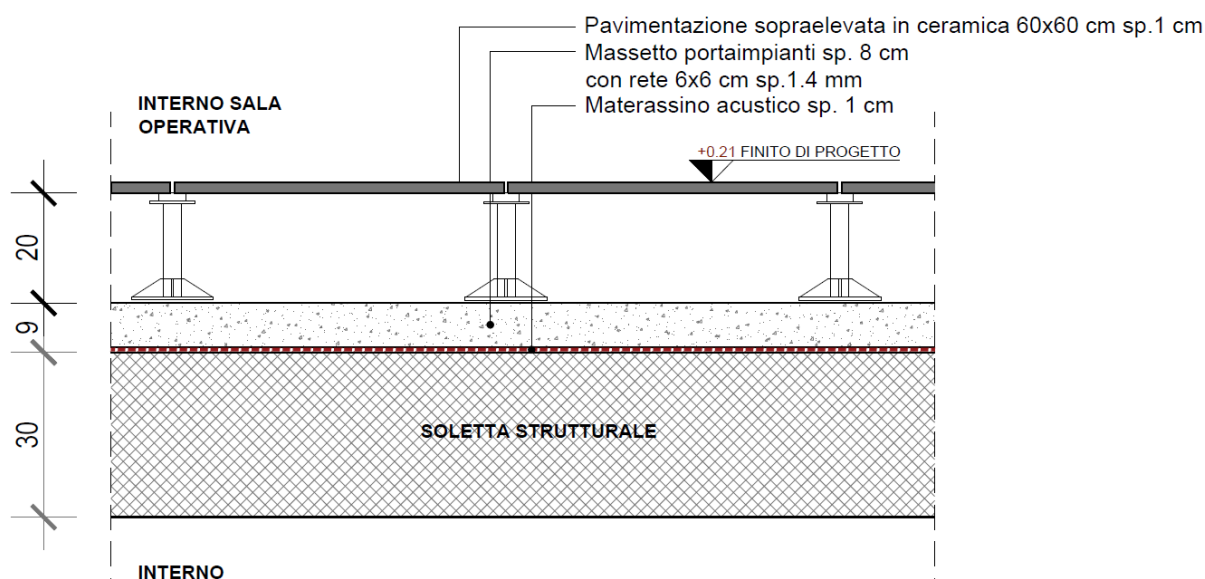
dettaglio della partizione interna orizzontale con pavimento sopraelevato
